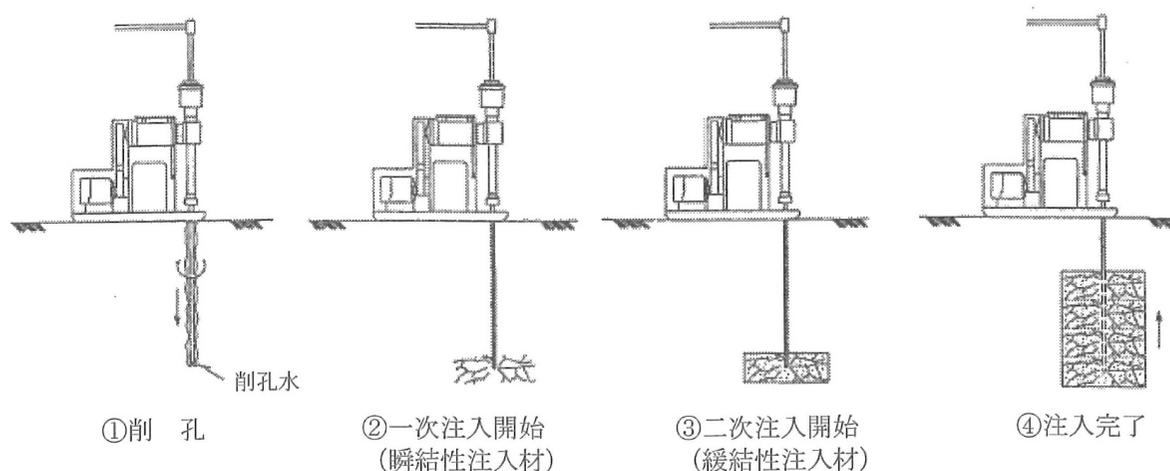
二重管ストレナーナ工法(複相タイプ)の施工手順
